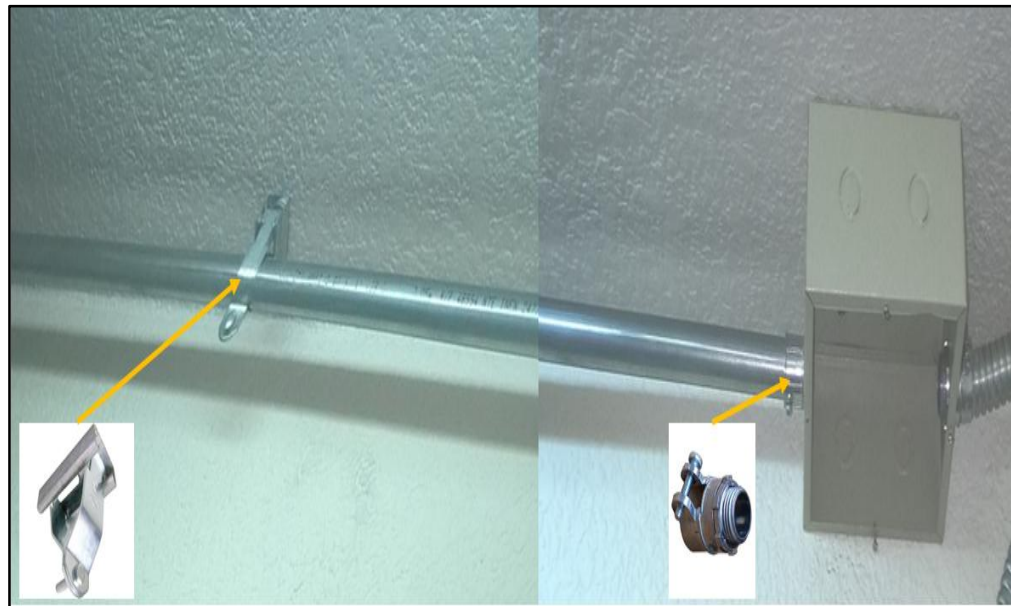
Accesorios de 1 pulgada de tubería Conduit y manguera metálica flexible
